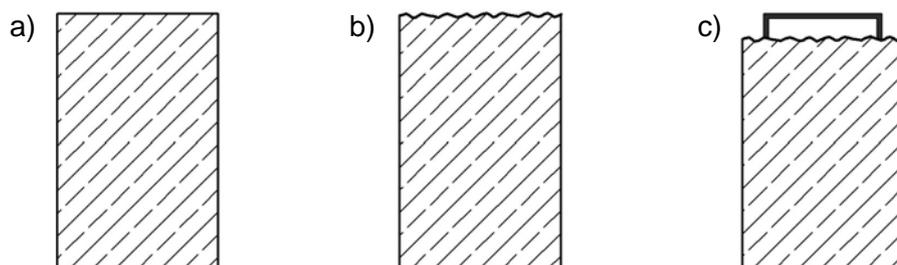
Oberflächenbeschaffenheiten für die Ergänzung durch Aufbeton
